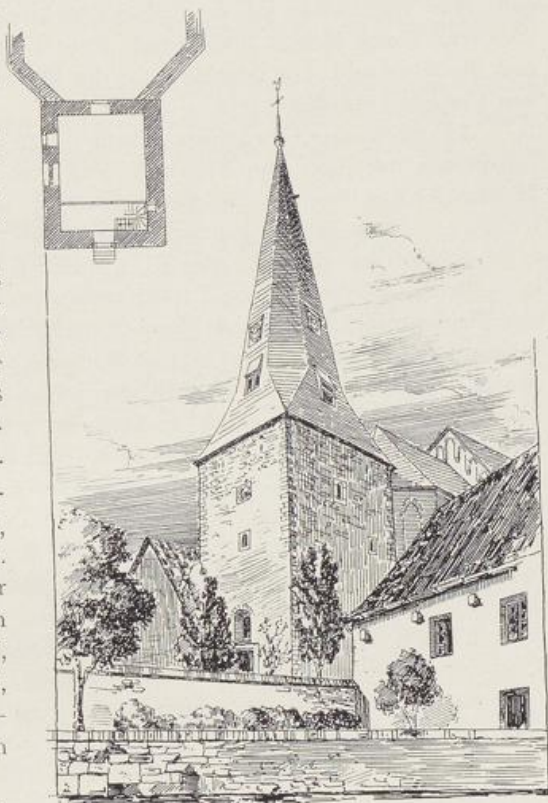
Vettweiss. Grundriss und Ansicht des Turmes der kathol. Pfarrkirche.
